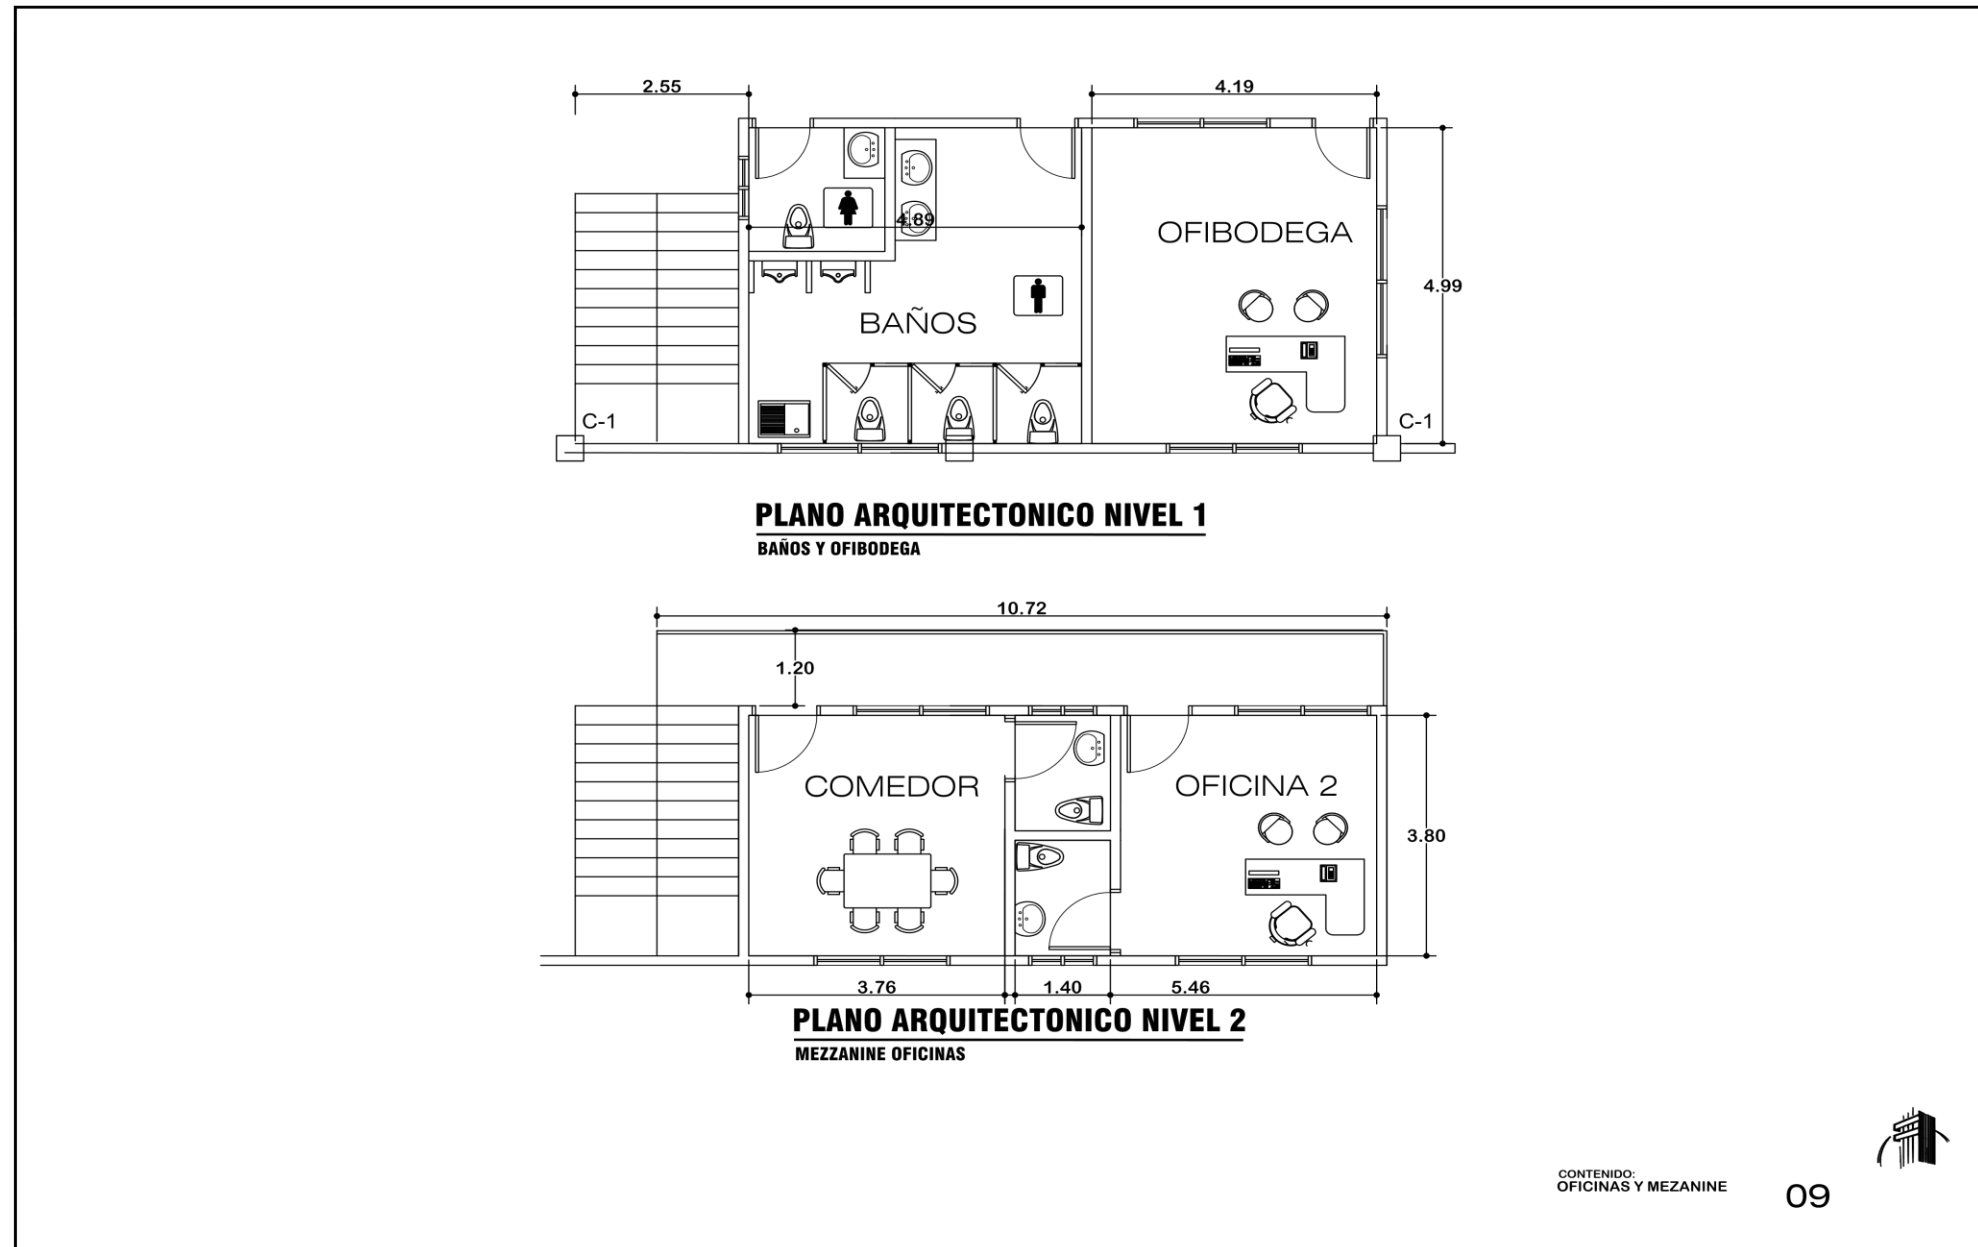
Plano arquitectónico del nivel 1 y 2
